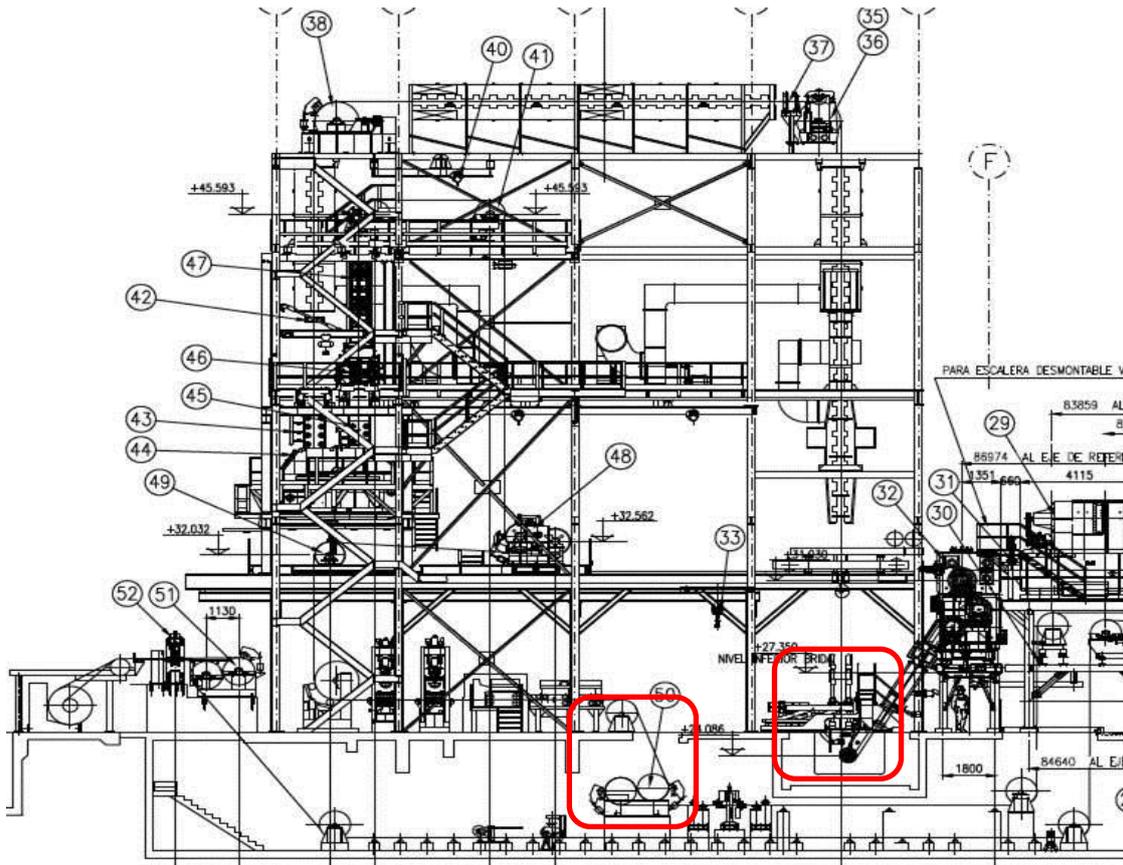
Ubicación en planta del pote de galvanizado y del equipo Eberline
